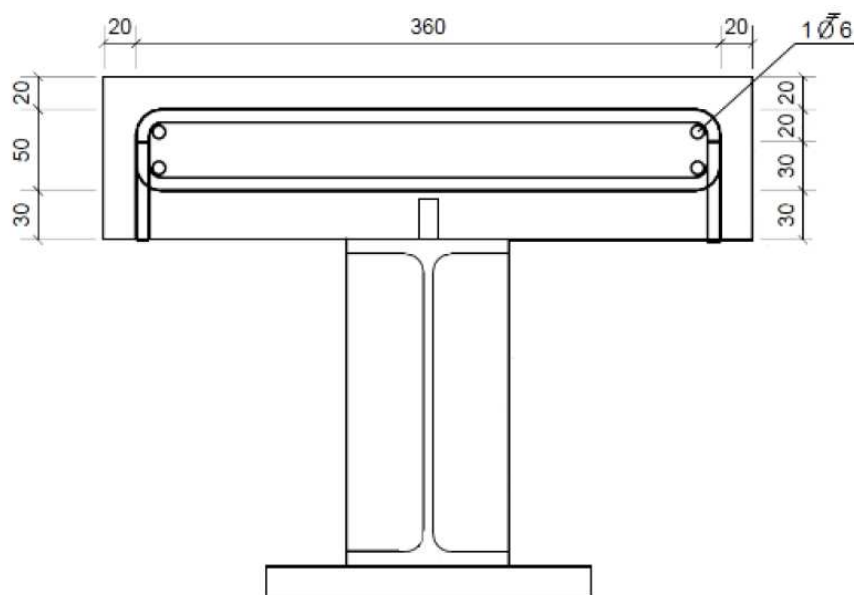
Armadura na seção transversal da viga mista (dimensões em mm) (ALVES, 2014).
